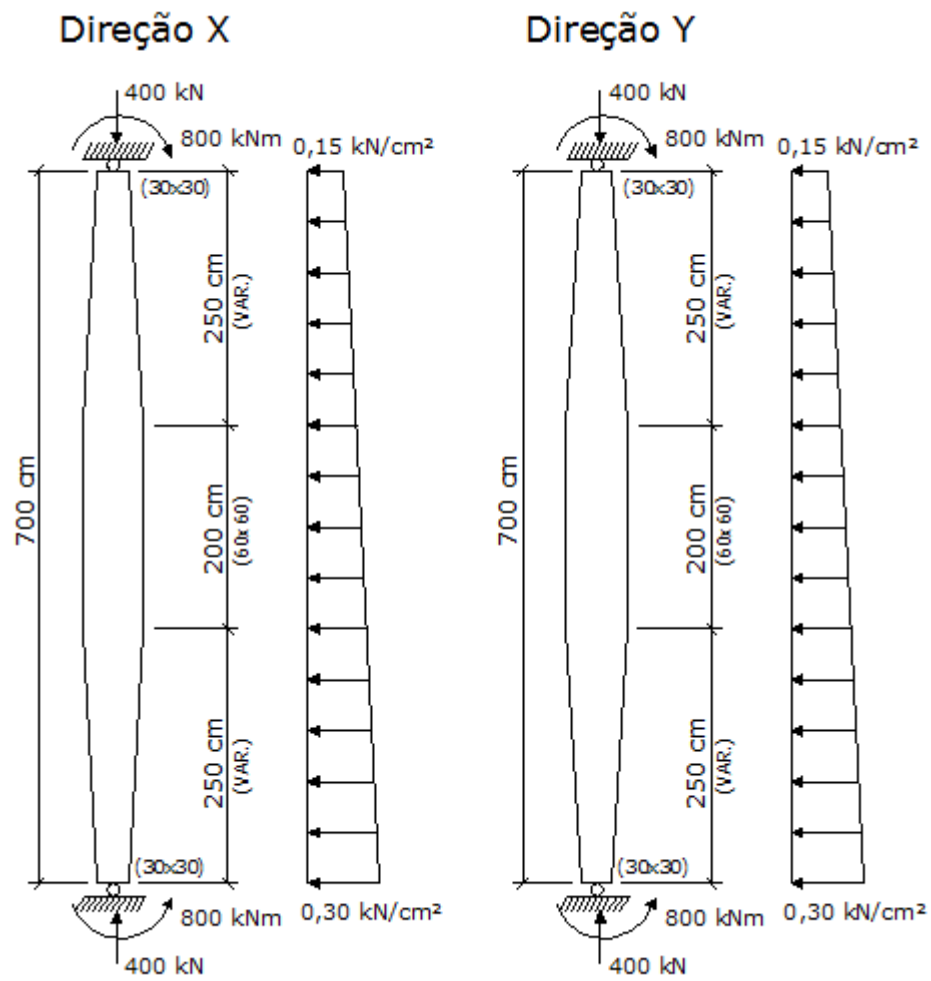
exemplo de aplicação: pilar bi-rotulado.
